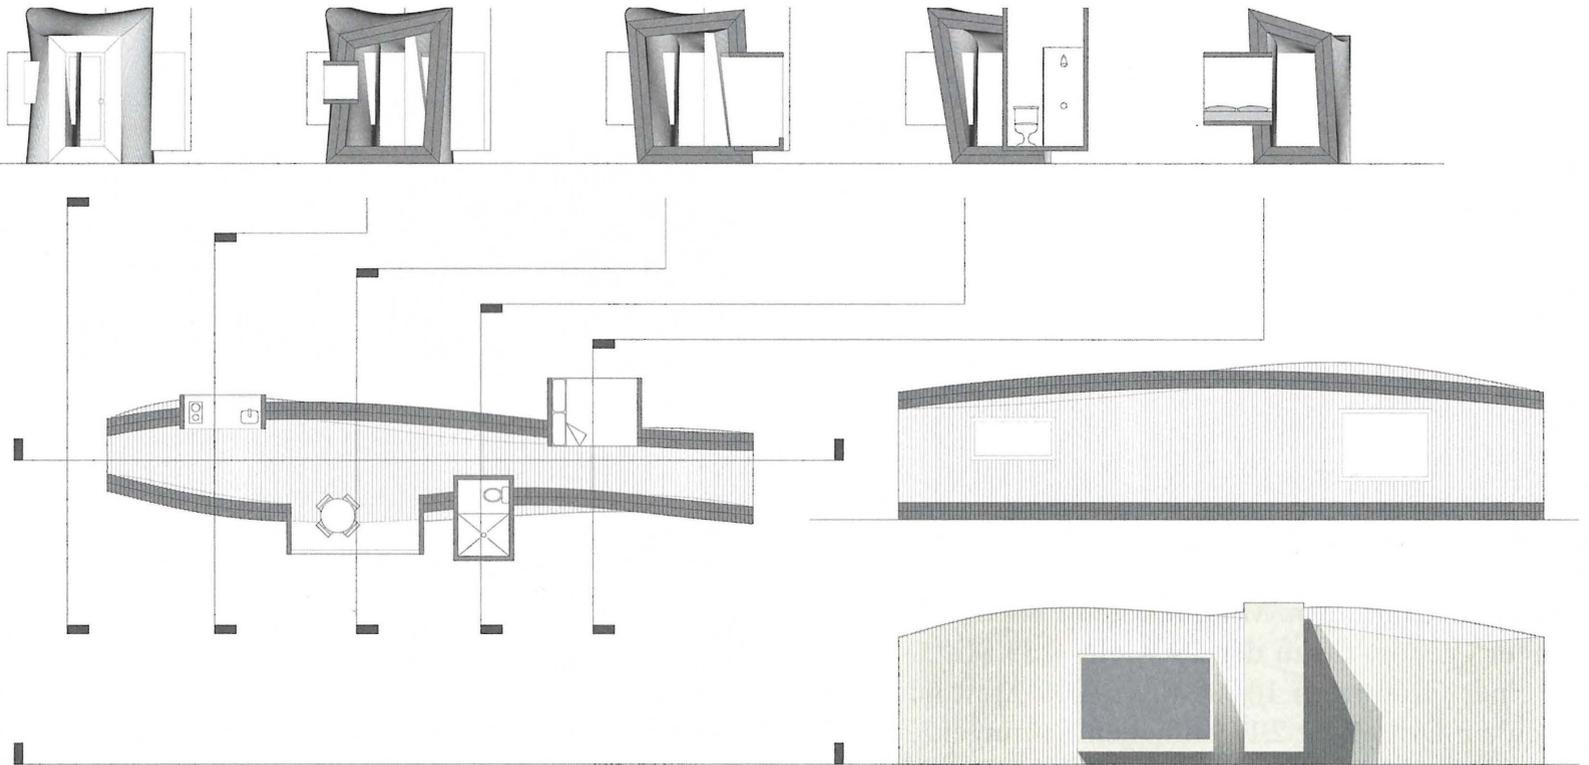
IBA Timber Prototype. Grundrisse, Schnitte und Ansicht einer der parametrischen Entwurfsiterationen
